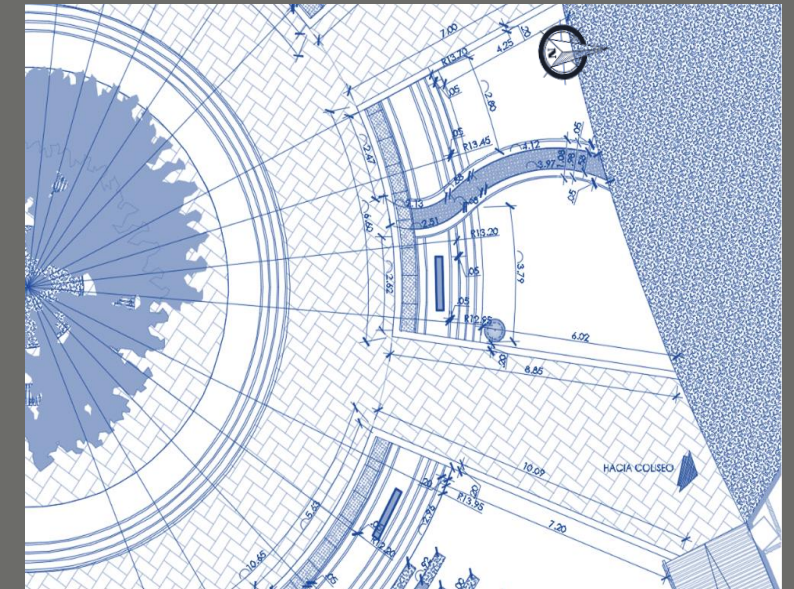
Segmento de planta acotada de Plaza Secundaria-Módulos Comerciales. Ver lámina en anexo N°1.
